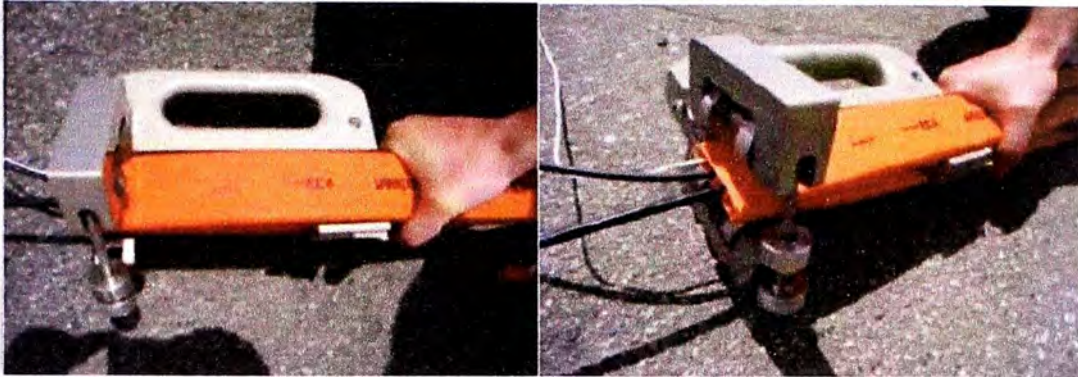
Colocación de la segunda canaleta en la herramienta de ensamblado (Fuente Ref. [5])
